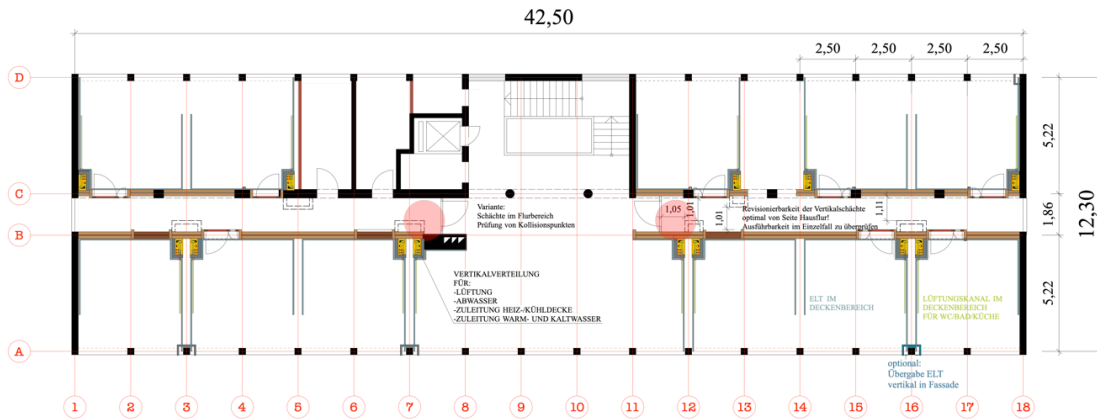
Überprüfung der Grundrissgeometrie der kleinsten Einheit Untersuchungsobjekt 2
